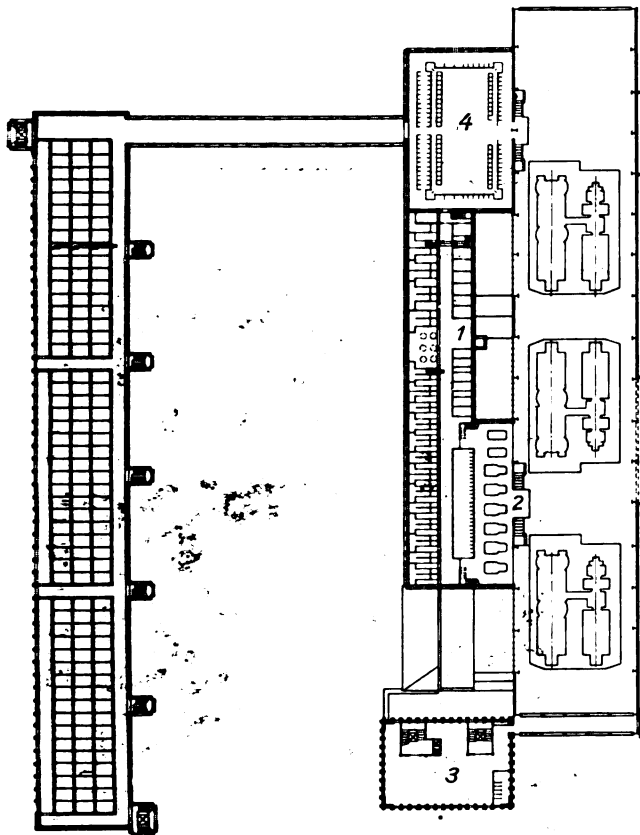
Grundriß des Maschinenhauses mit Vorbauten und des 30 kV-Schalthauses.
